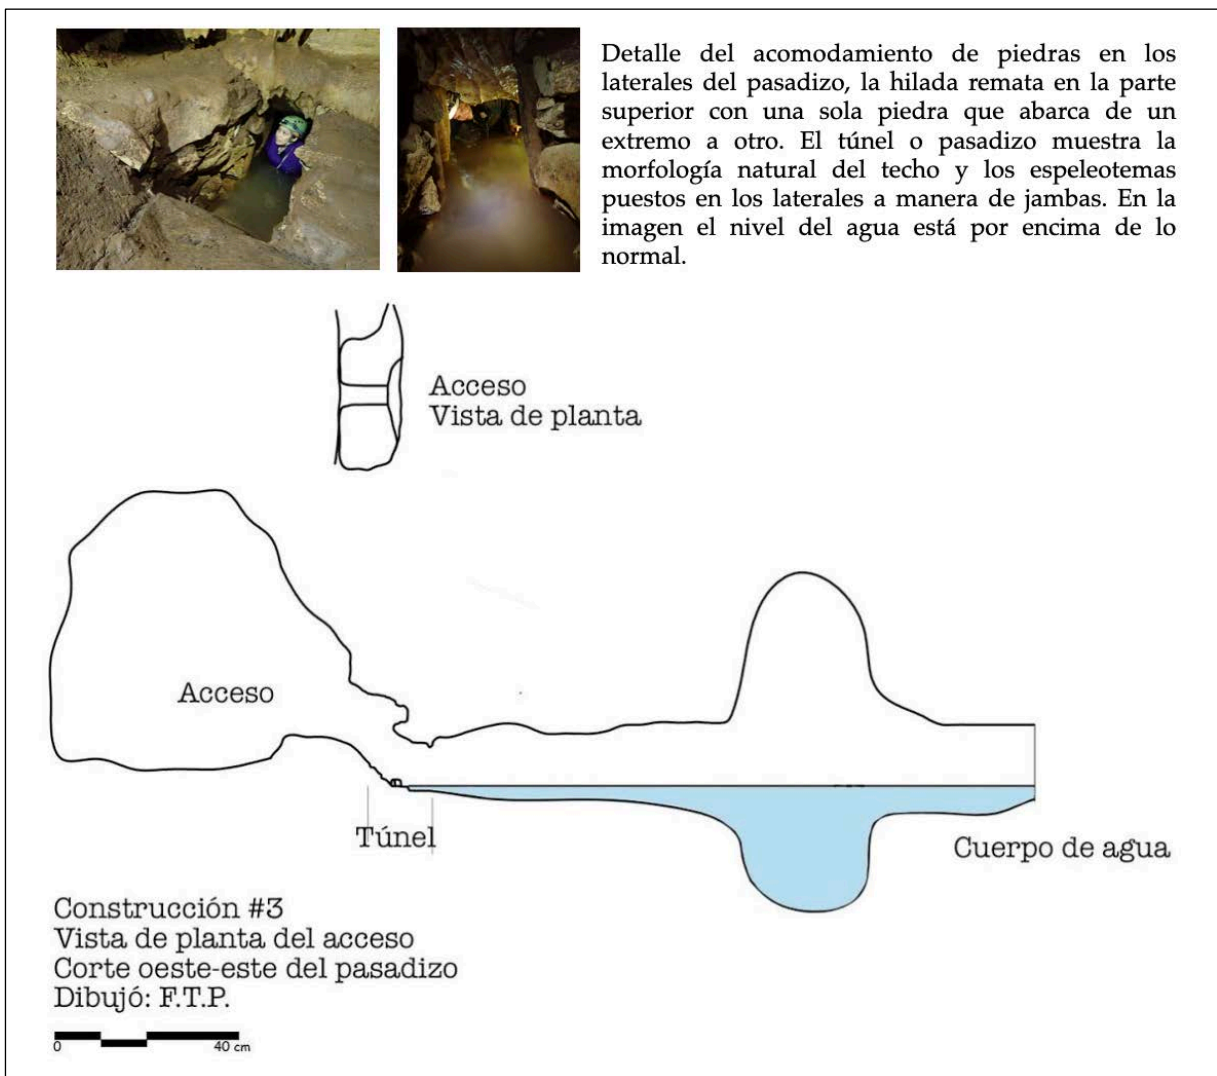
Fachada principal y del acceso de la Contrucción #3. Detalle del acomodamiento de piedras en los laterales, el túnel o pasadizo y dibujo del corte de las galerías donde se encuentra la construcción. Fotos: María Gómez y Fátima Tec. Dibujo: Fátima Tec.
